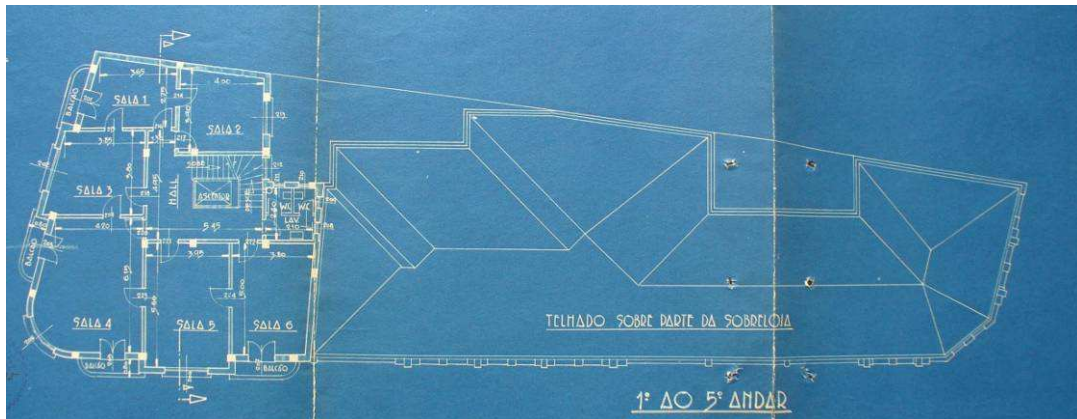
Planta do pavimento-tipo, projeto nº182 de Gouvea & Cunha. Edifício Santana
